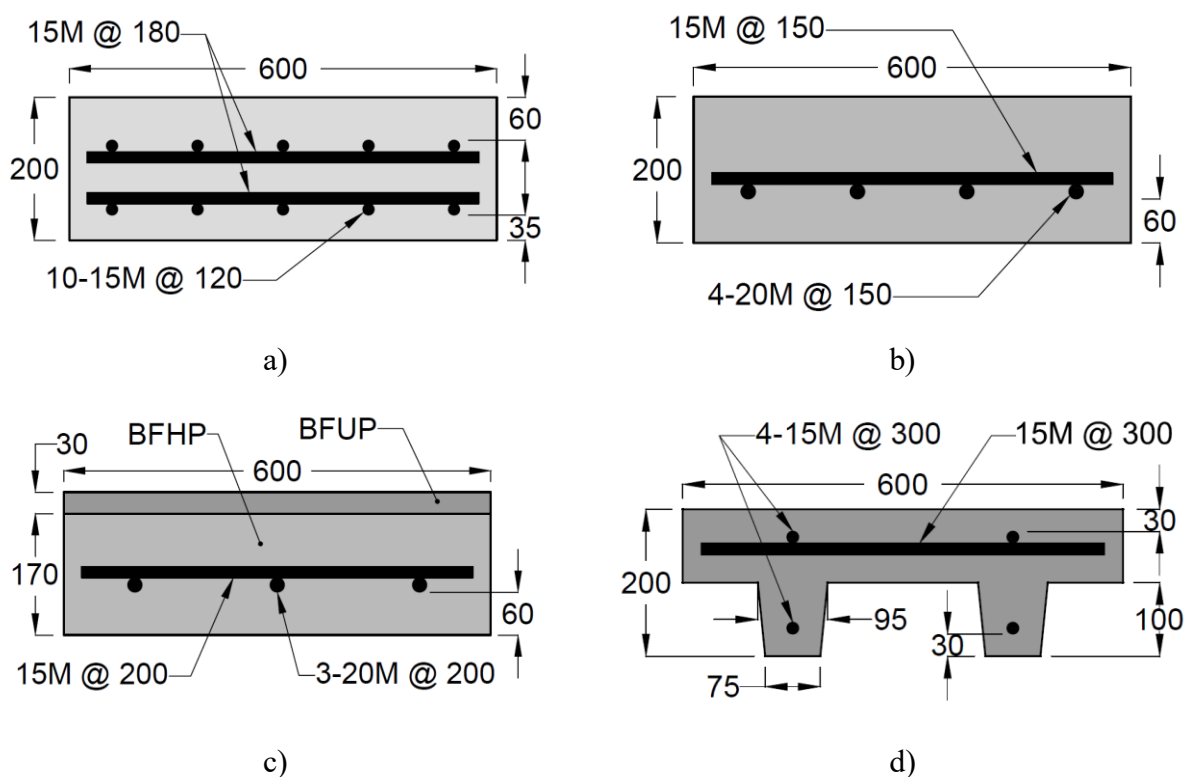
Concepts de dalles préfabriquées en BRF de Lachance (2015), a) Dalle en BHP, b) Dalle en BFHP, c) Dalle hybride en BFHP et BFUP, d) Dalle en BFUP
